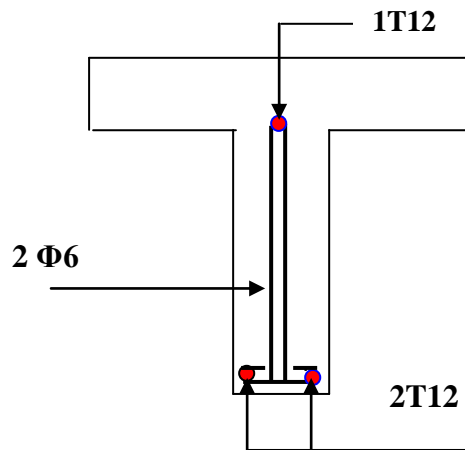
Schéma de ferrailage plancher terrasse
